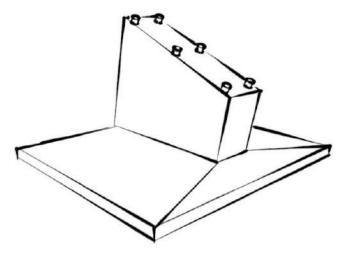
Cimentación con inclinación para el apoyo de cerchas. Fuente: Elaboración propia. (2018).
